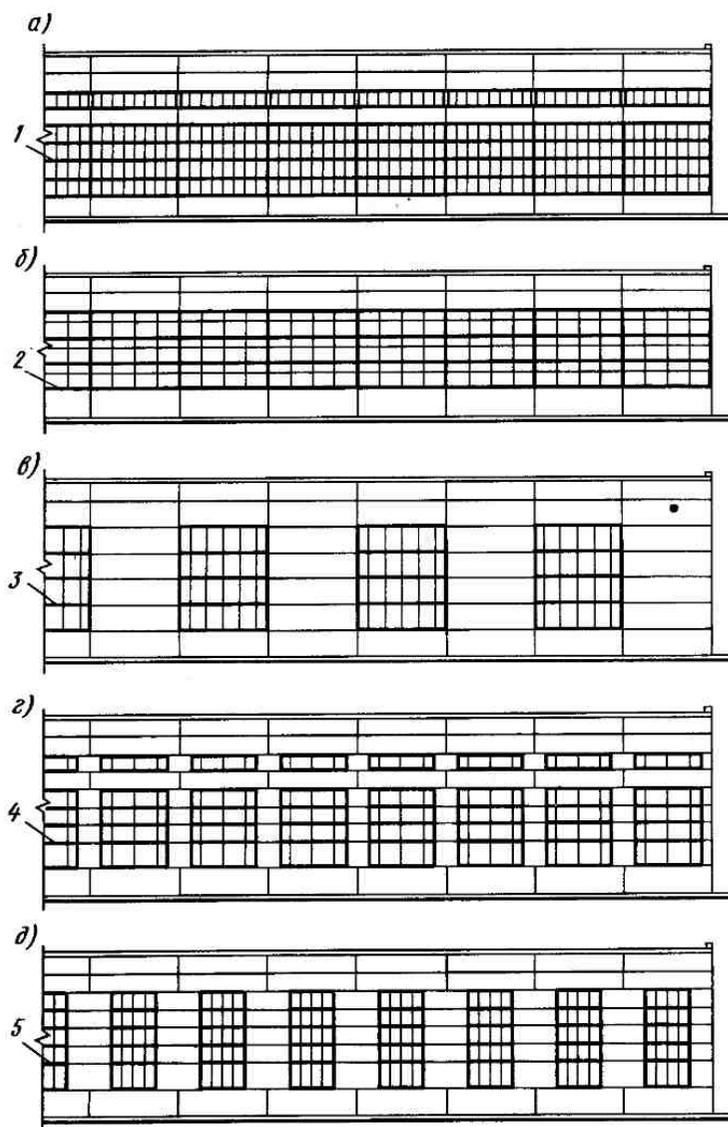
Варианты разрезки стен одноэтажных зданий:
